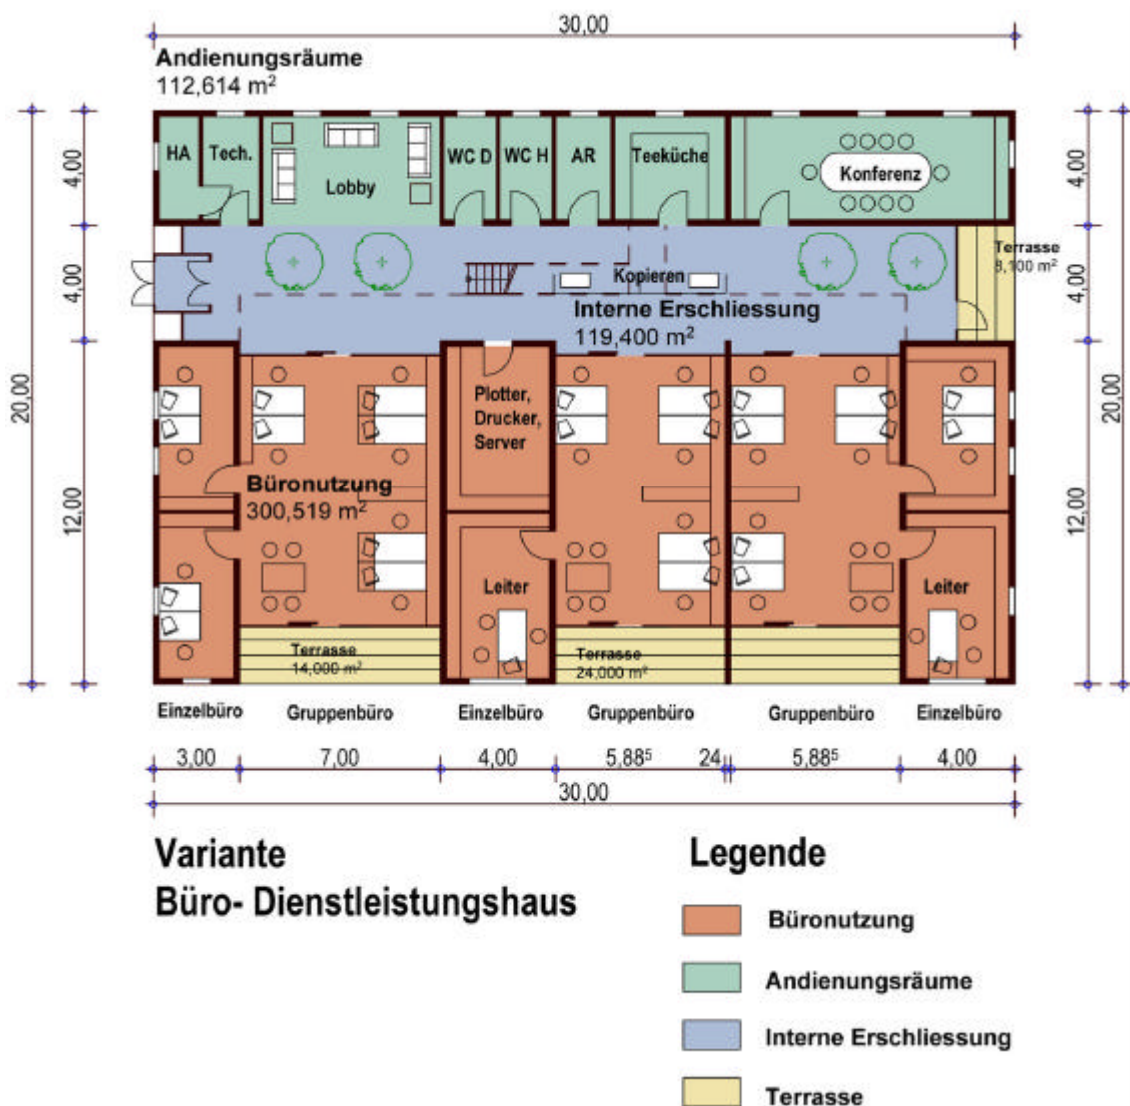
Variante A Büro/ Dienstleistung, Erdgeschoß¹
